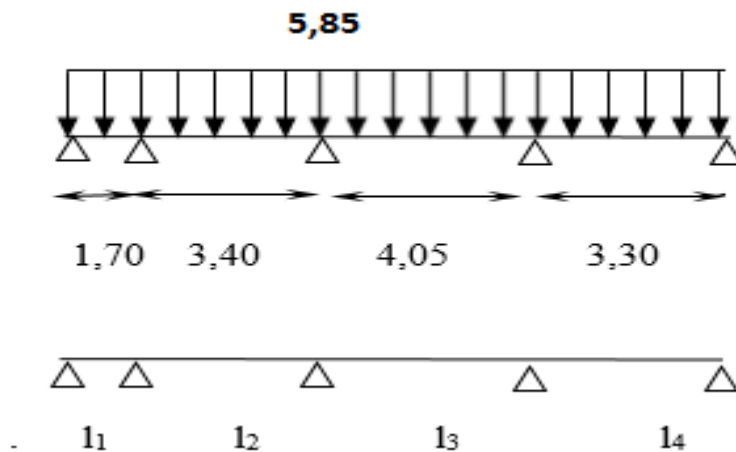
chargement du 2^{eme} type de poutrelles
